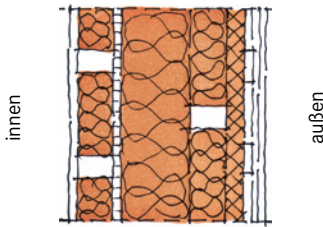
Systemdetails Neubau – KfW Effizienzhaus 70
